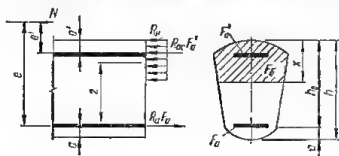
Схема расположения усилий в поперечном сечении внецентренно сжатого по случаю 1 железобетонного элемента при расчете его по прочности.
